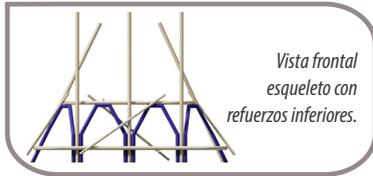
Imagen X Proceso constructivo de refuerzos inferiores, Elaboración propia.
